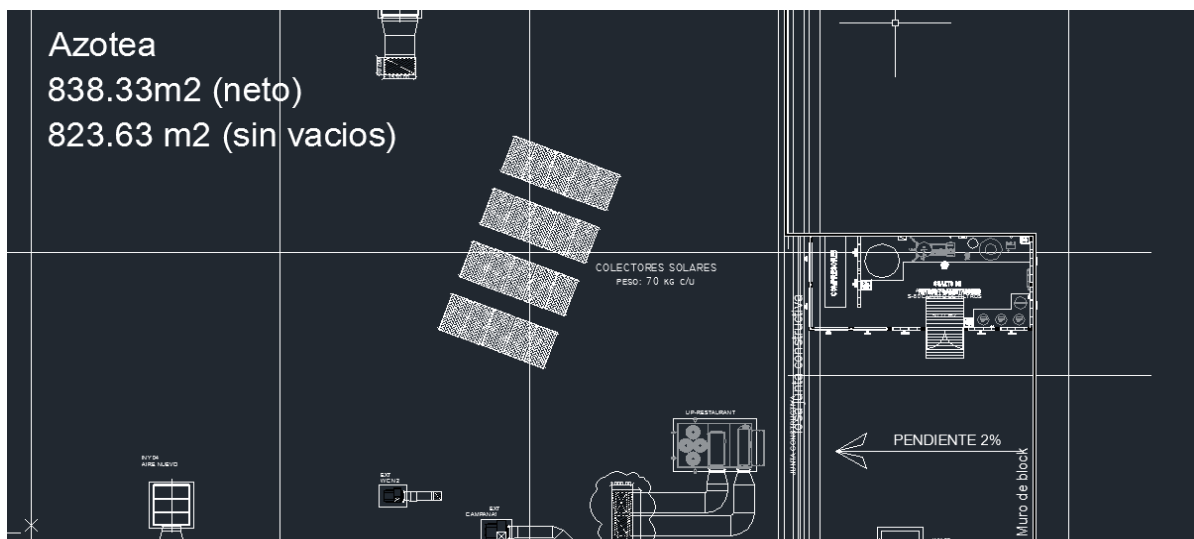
Plano de planta del área asignada a equipos de calentamiento de agua.
